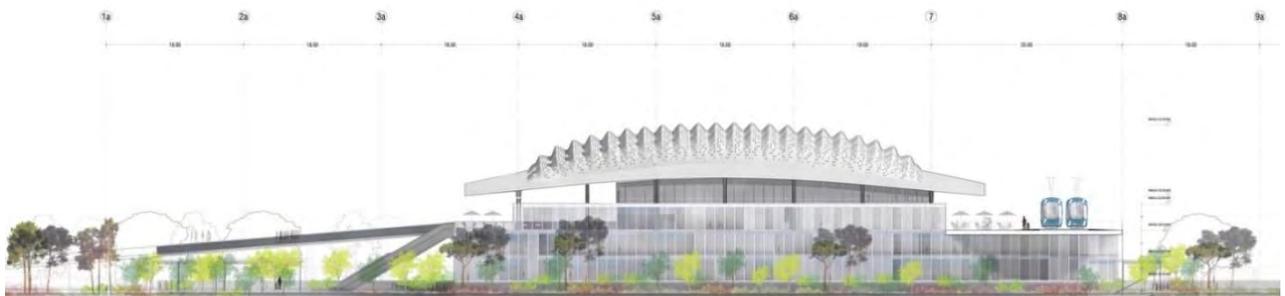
Железнодорожный вокзал в Монпелье, боковой фасад
